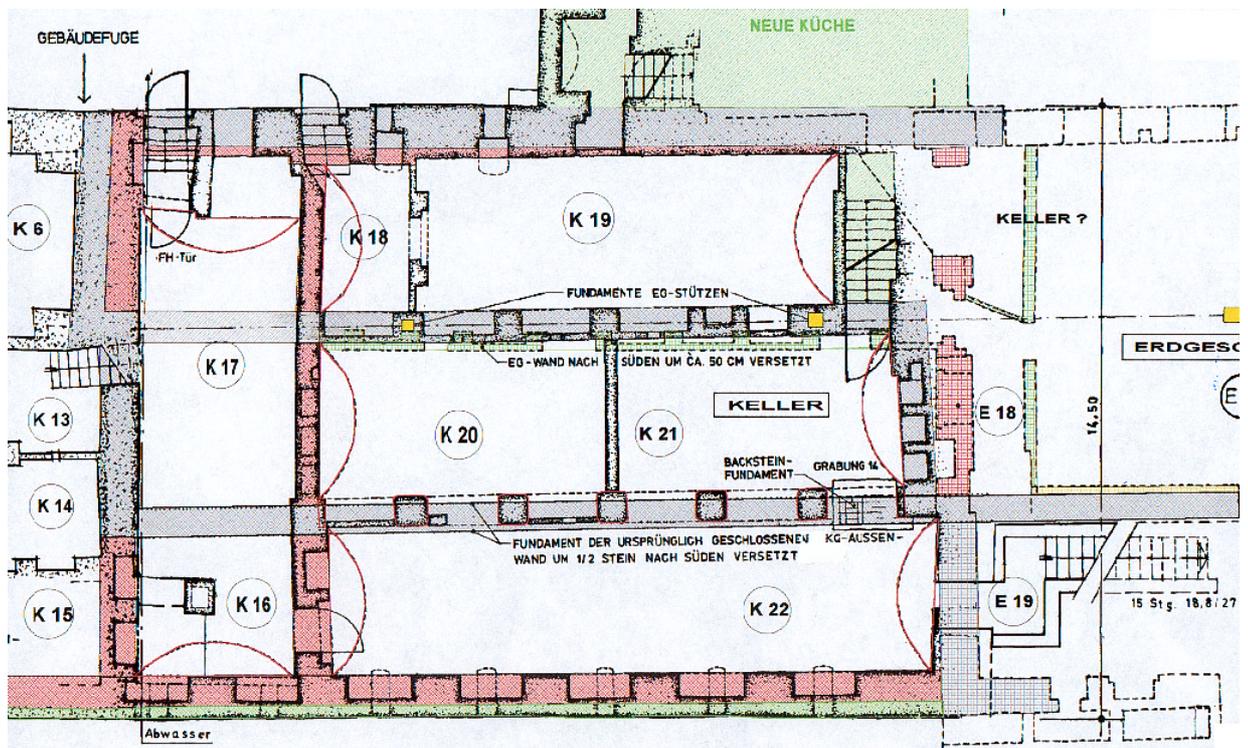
Keller- und Erdgeschossteilgrundriss zusammengesetzt
